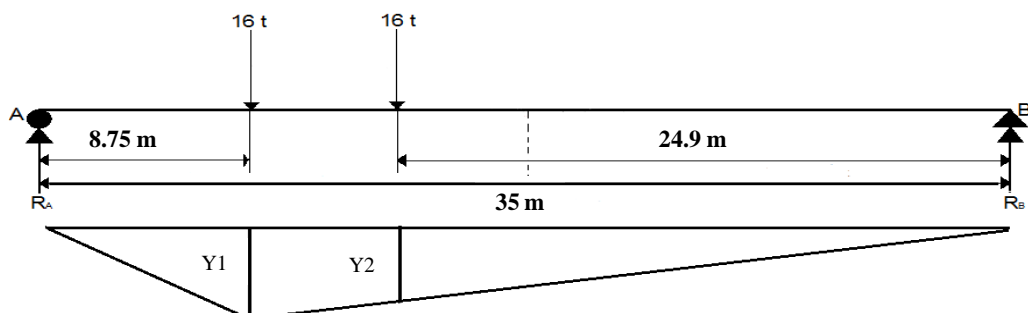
Disposition du convoi Bt (pour la section $x=0.25L$)
